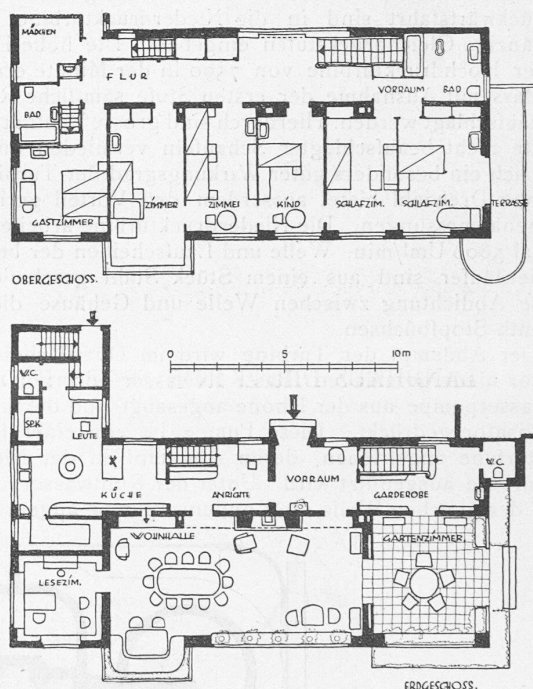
u. 2. Grundrisse zum Landhaus Dir. Z. in Klosterheide. — 1 : 300.
